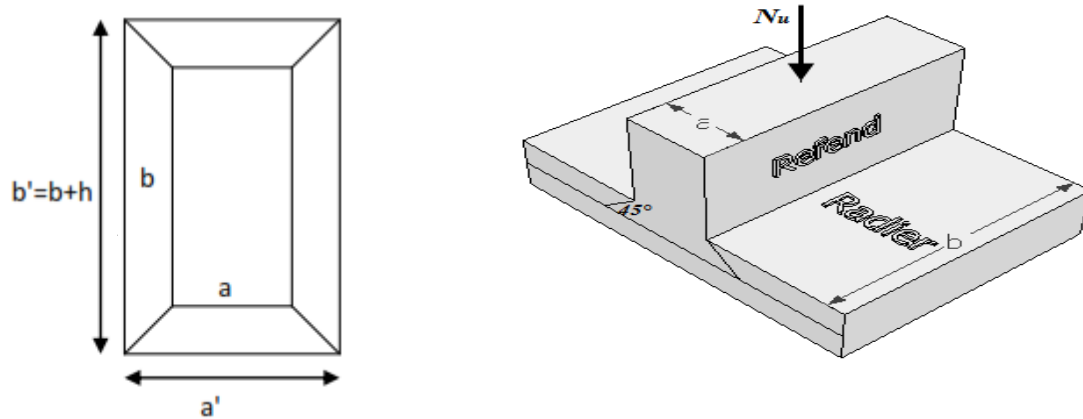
Périmètre utile des voiles et des poteaux.
